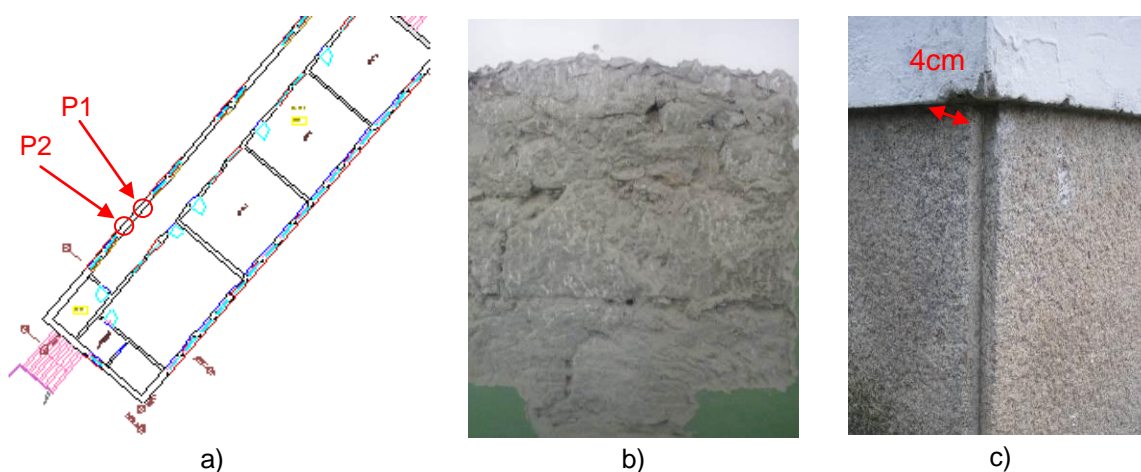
Elementos testados: a) localização; b) vista da alvenaria; c) rebaixamento verificado na zona inferior do pano exterior da parede.
